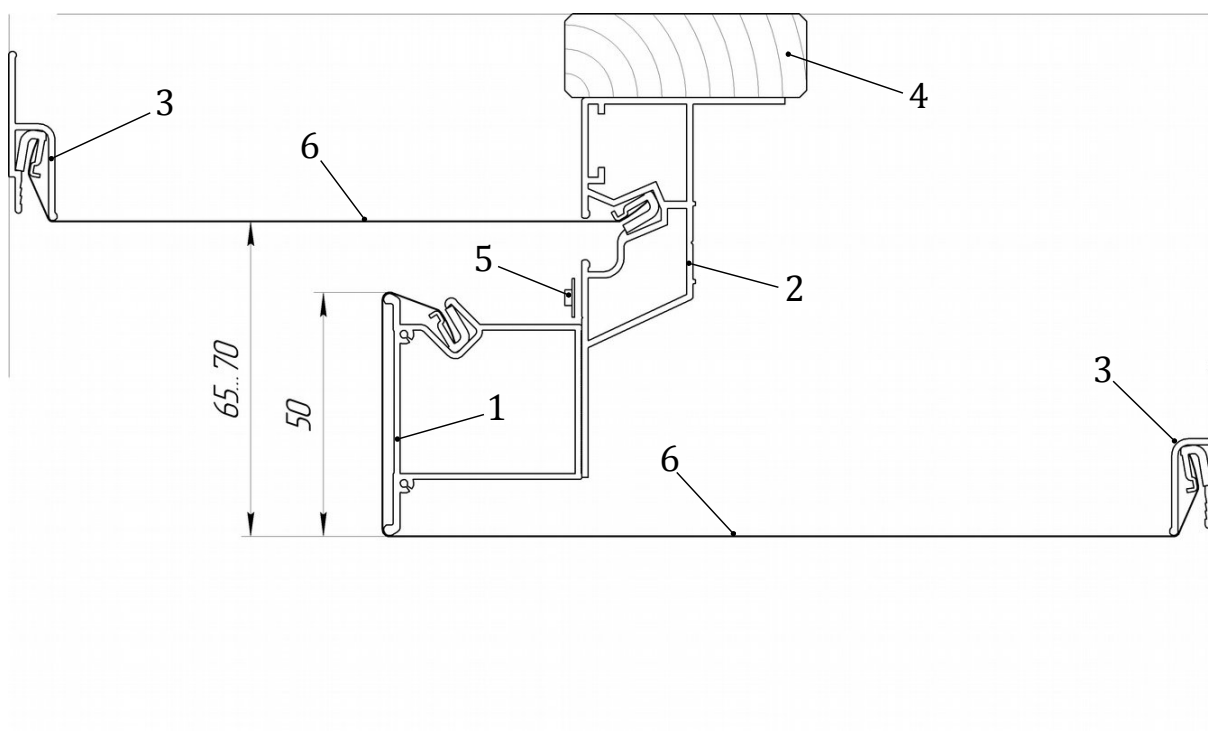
Применение профиля НП: ступенчатый переход с декоративной подсветкой
